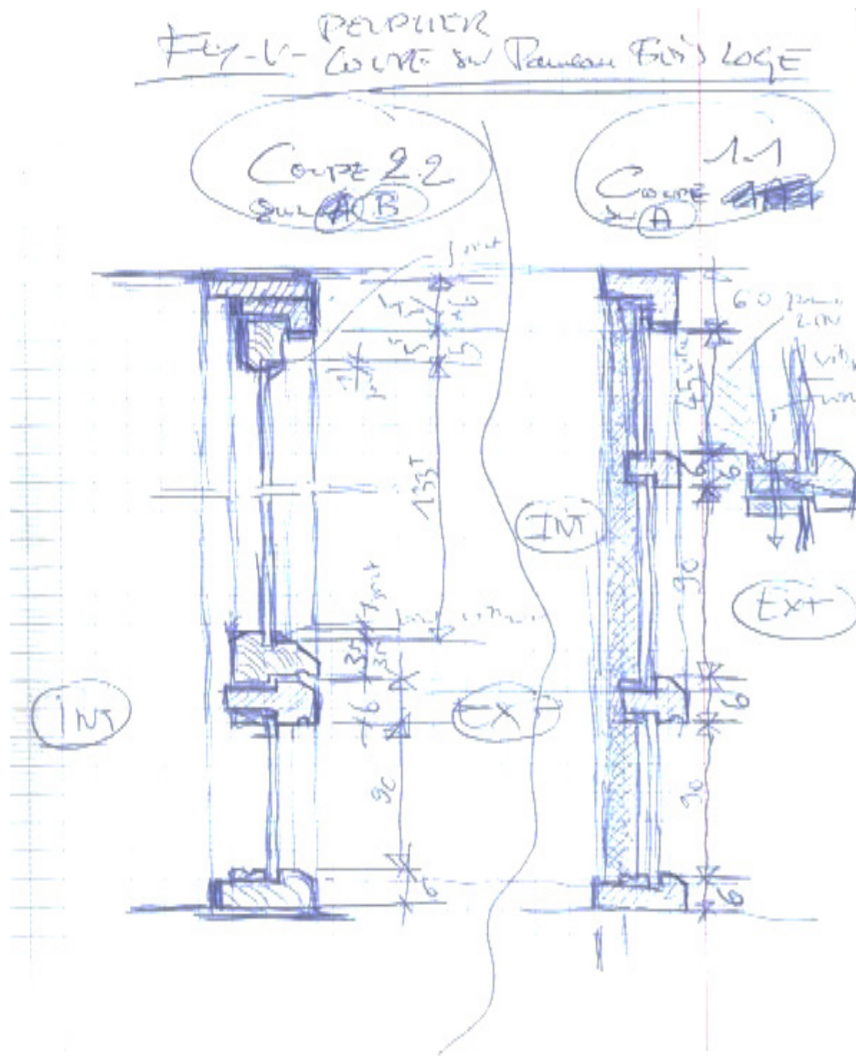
Détail façade extérieure | Panneau réhabilité type W (relevés sur site).
